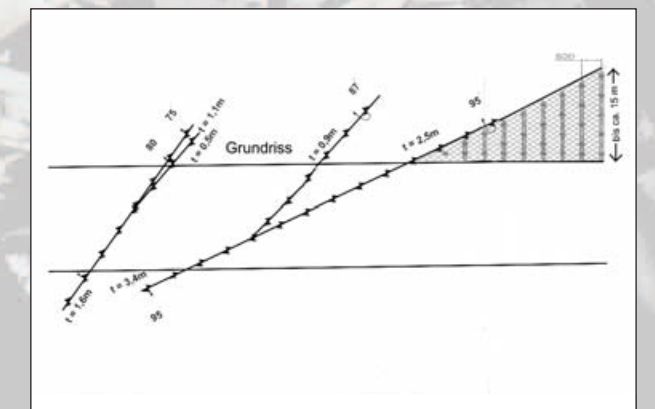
Maßnahmen Störungsdurchörterung Grundriss Bandstrecke.
